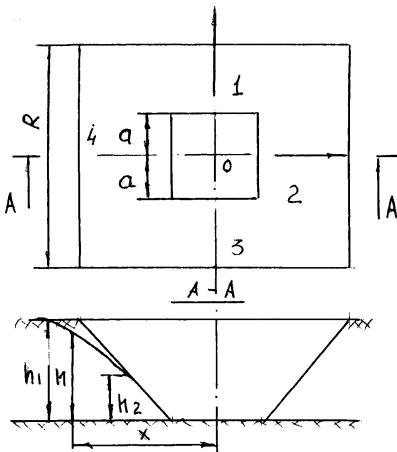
Схема к гидравлическому расчету притока воды в квадратный совершенный котлован с дном на кровле водоупора: а — план котлована; б — разрез котлована по А-А; 1, 2, 3, 4 — фрагменты.
